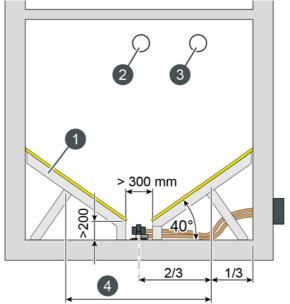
Construction du plancher incliné en cas de sondes d'aspiration
